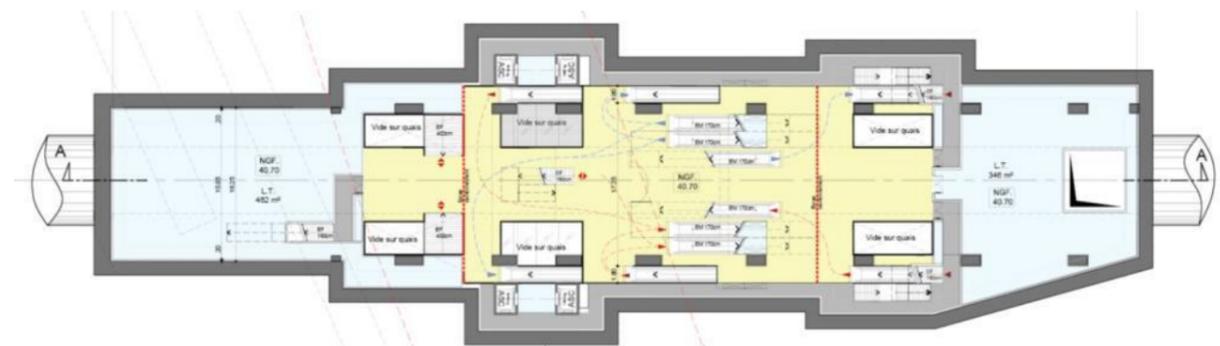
Gare d'Arcueil Cachan – Plan niveau N-3
